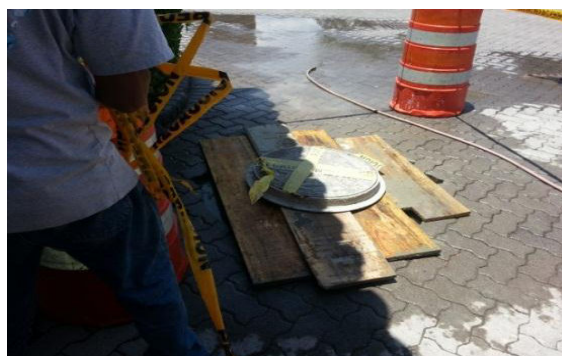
protección que se le dejó al pozo para que el concreto secase.
